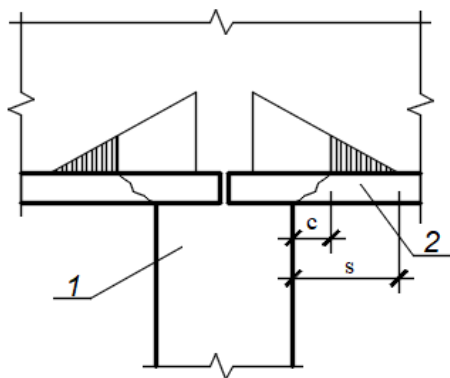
Схема до визначення поперечної сили на опорі рандбалки:
